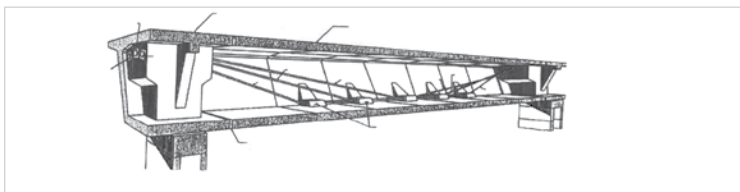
Разрез по длине эстакады из сборных крупногабаритных железобетонных конструкций, опирающихся на колонны-быки со стальными напряженными стягивающими канатами, закрепленными в анкерах и промежуточных опорах
